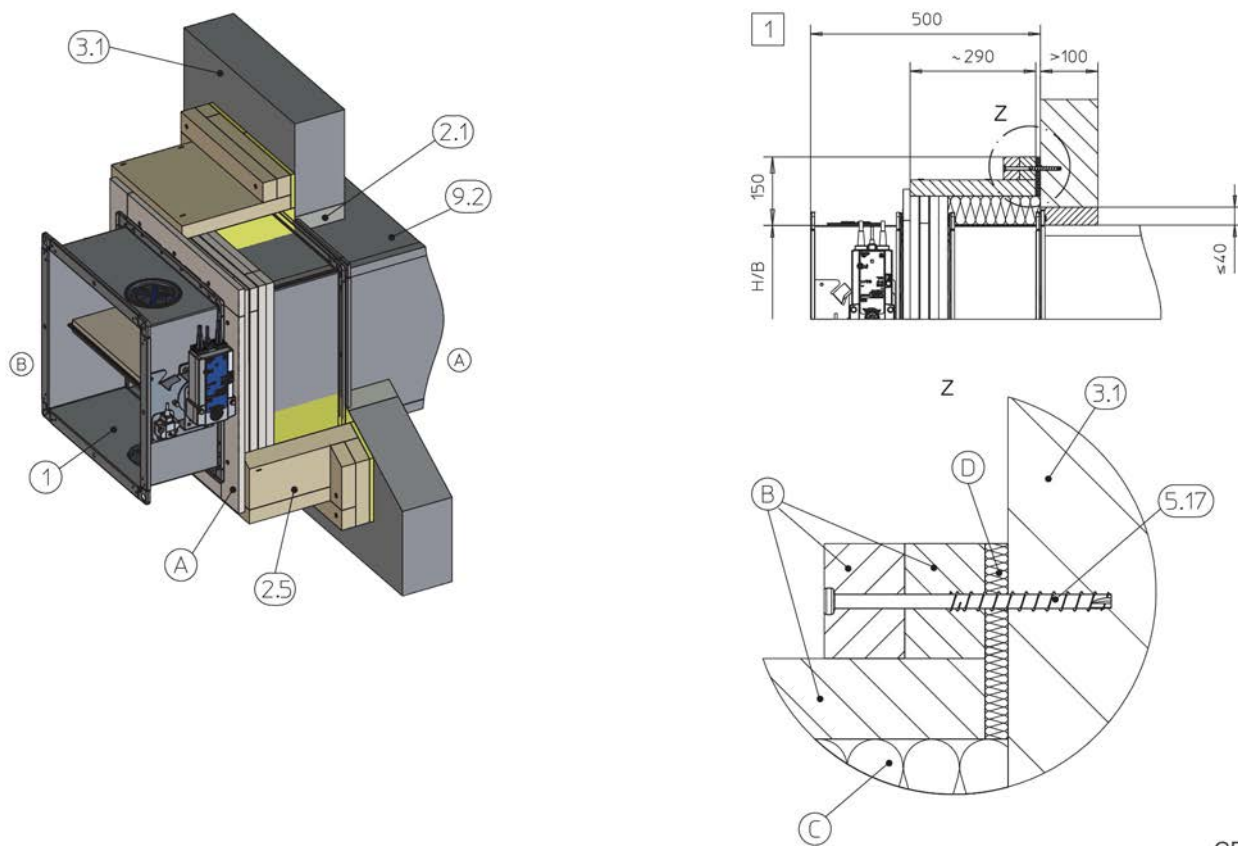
installazione in muratura in un muro solido, con muratura parziale
